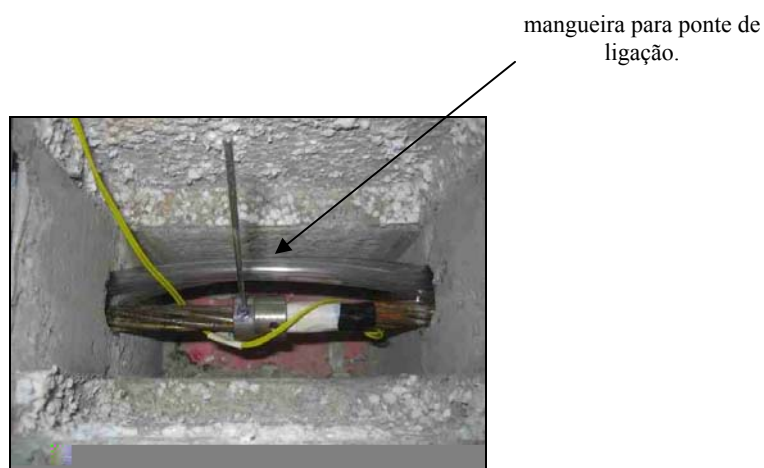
PONTE DE LIGAÇÃO PARA INJEÇÃO
